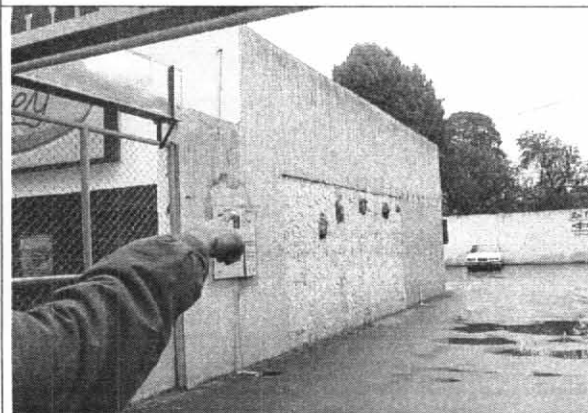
La demolición de la construcción (sector parqueadero) ha dejado en evidencia características de la construcción.
